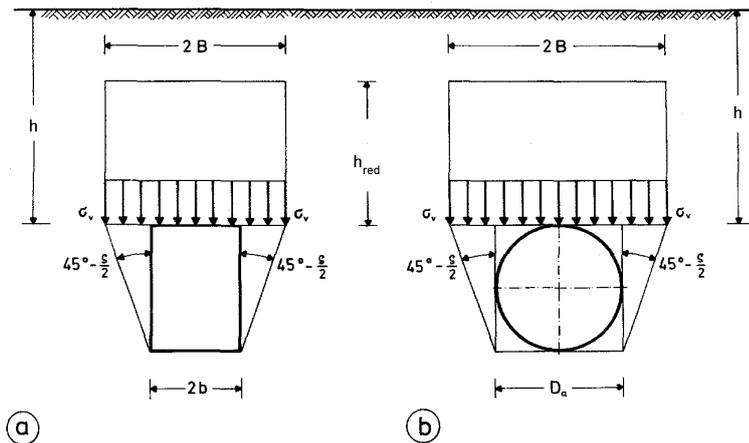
Scherflächenausbildung für Rechteckprofile [26]
